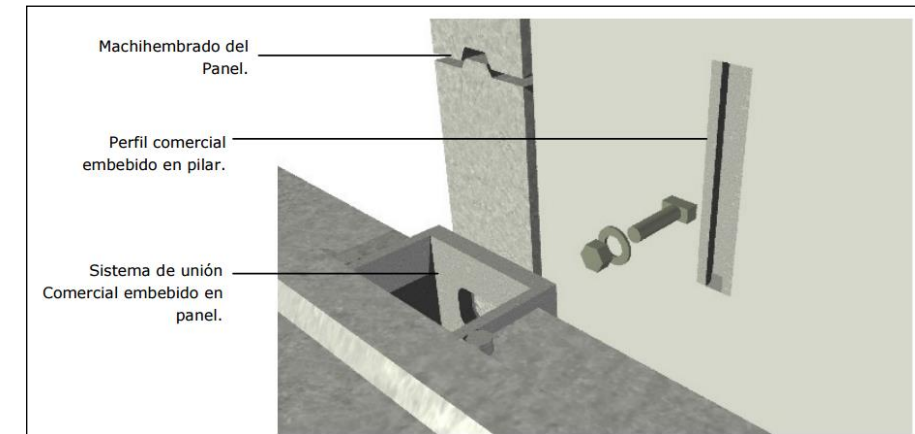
h. Arriostramiento de los paneles a los pilares. Fuente: Catálogo técnico PACADAR
